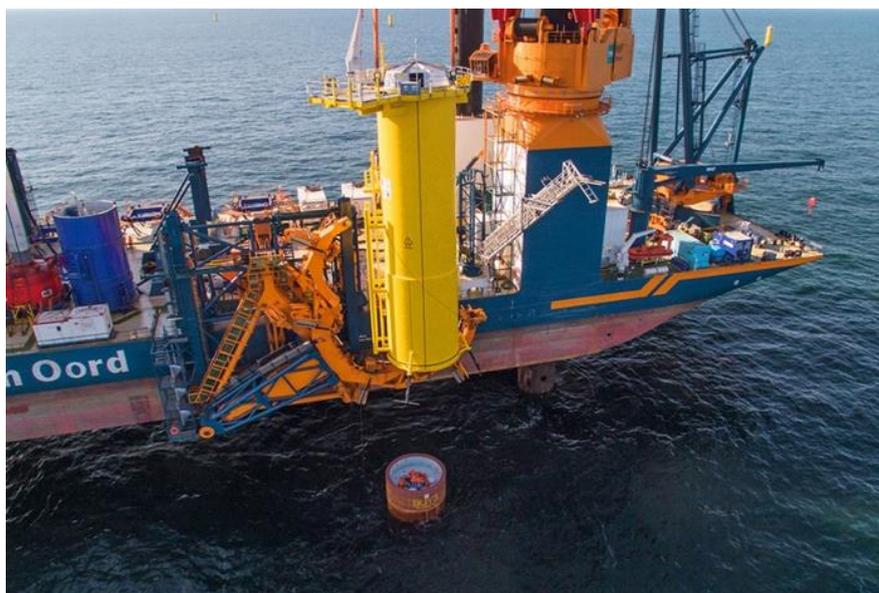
Installazione dell'elemento di transizione sulla fondazione
